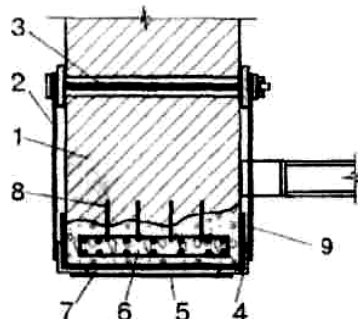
Схема підсилення кам'яної конструкції металевою обіймою:
